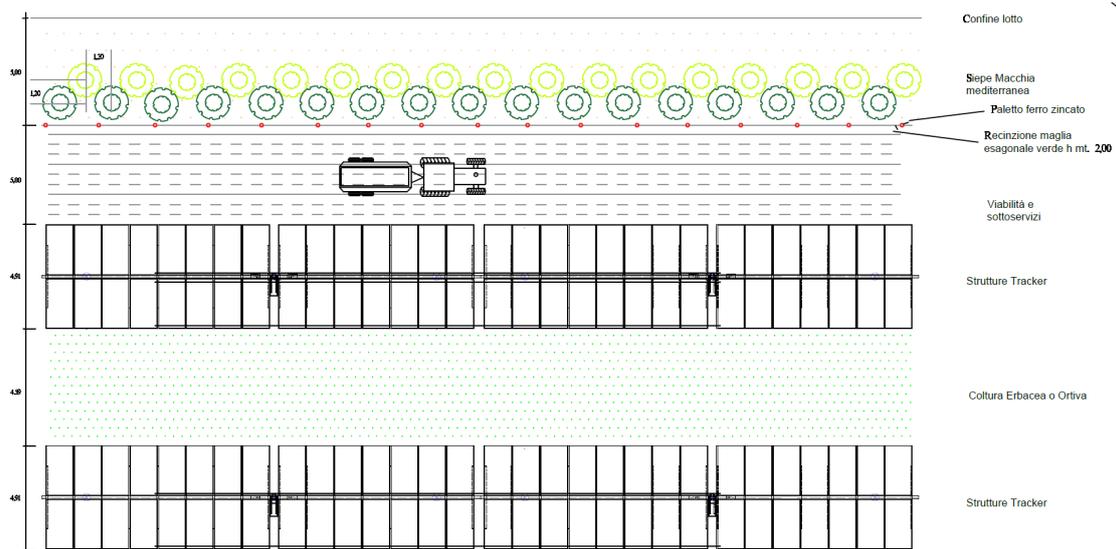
Schema planimetrico agrivoltaico di progetto con mitigazione a schermatura
